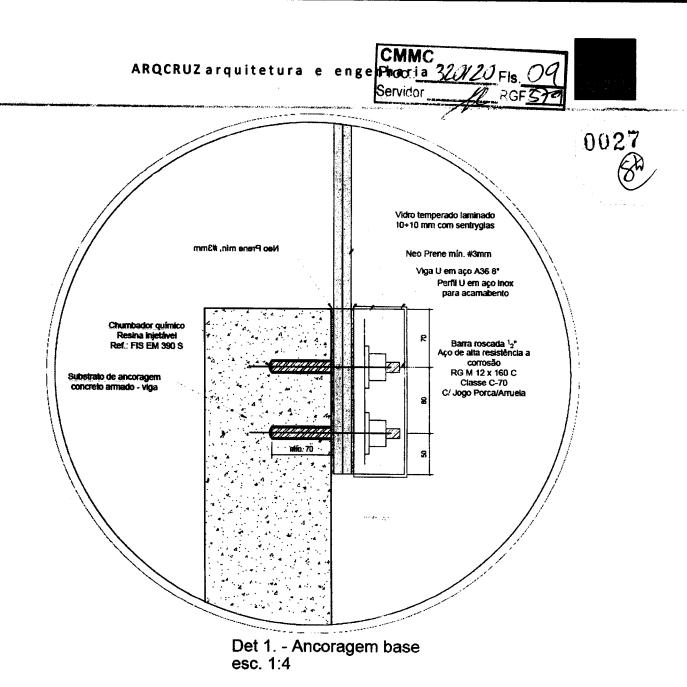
Detalhe 1, ancoragem da base do vidro em estrutural de concreto armado.
